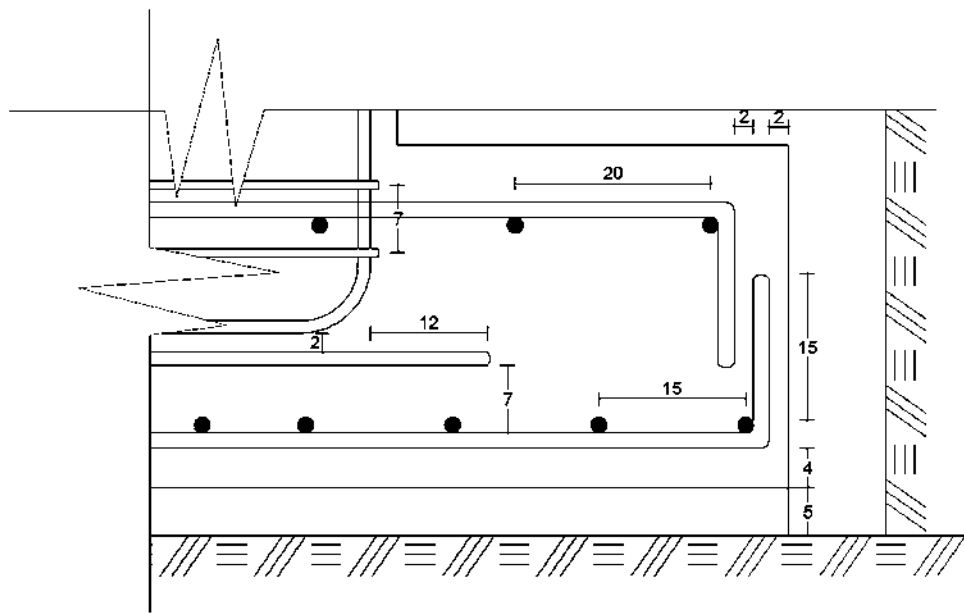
(f) Detallado de la zapata en para ambas direcciones de la zapata de la nave industrial, (cm)
